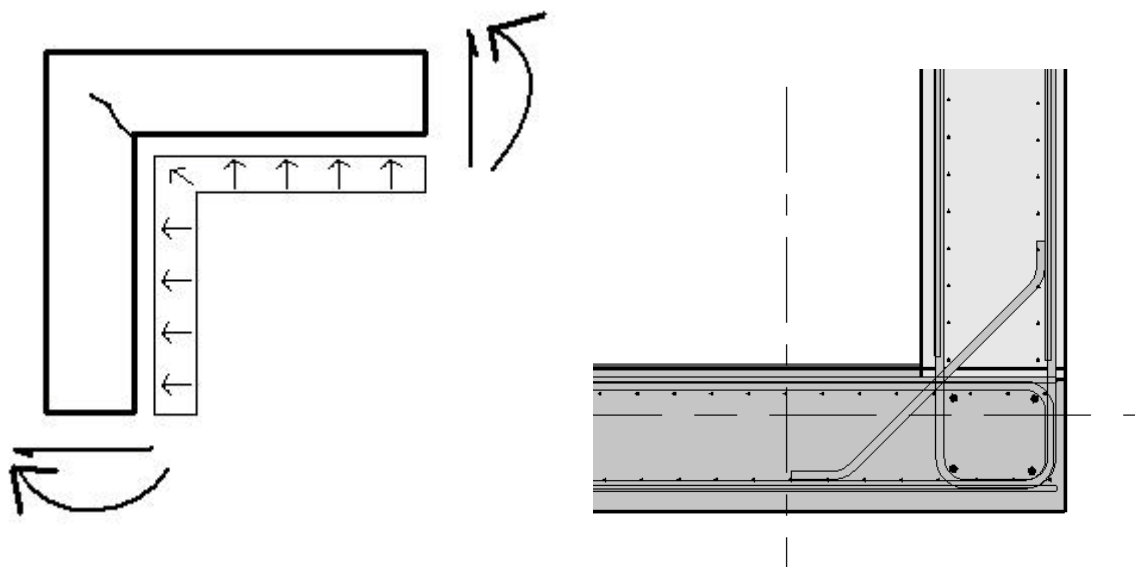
hovedarmering, 2-horisontalarmering, 3-vertikalarmering, 4-trykkarmering
